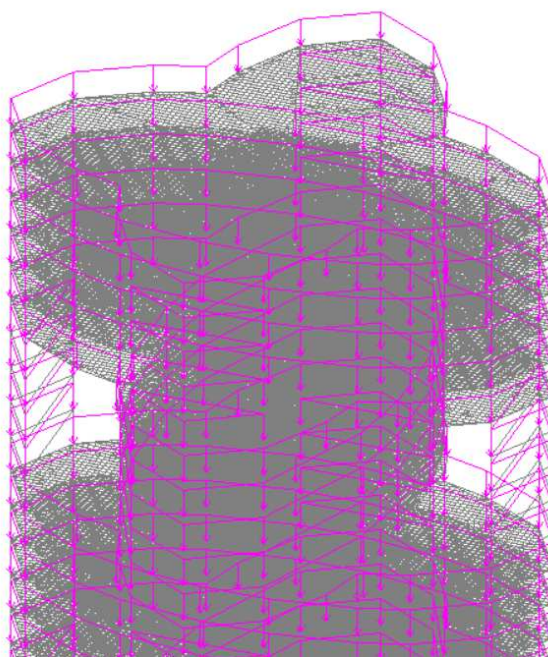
Нагрузка от фасадного остекления (по всей высоте здания)
